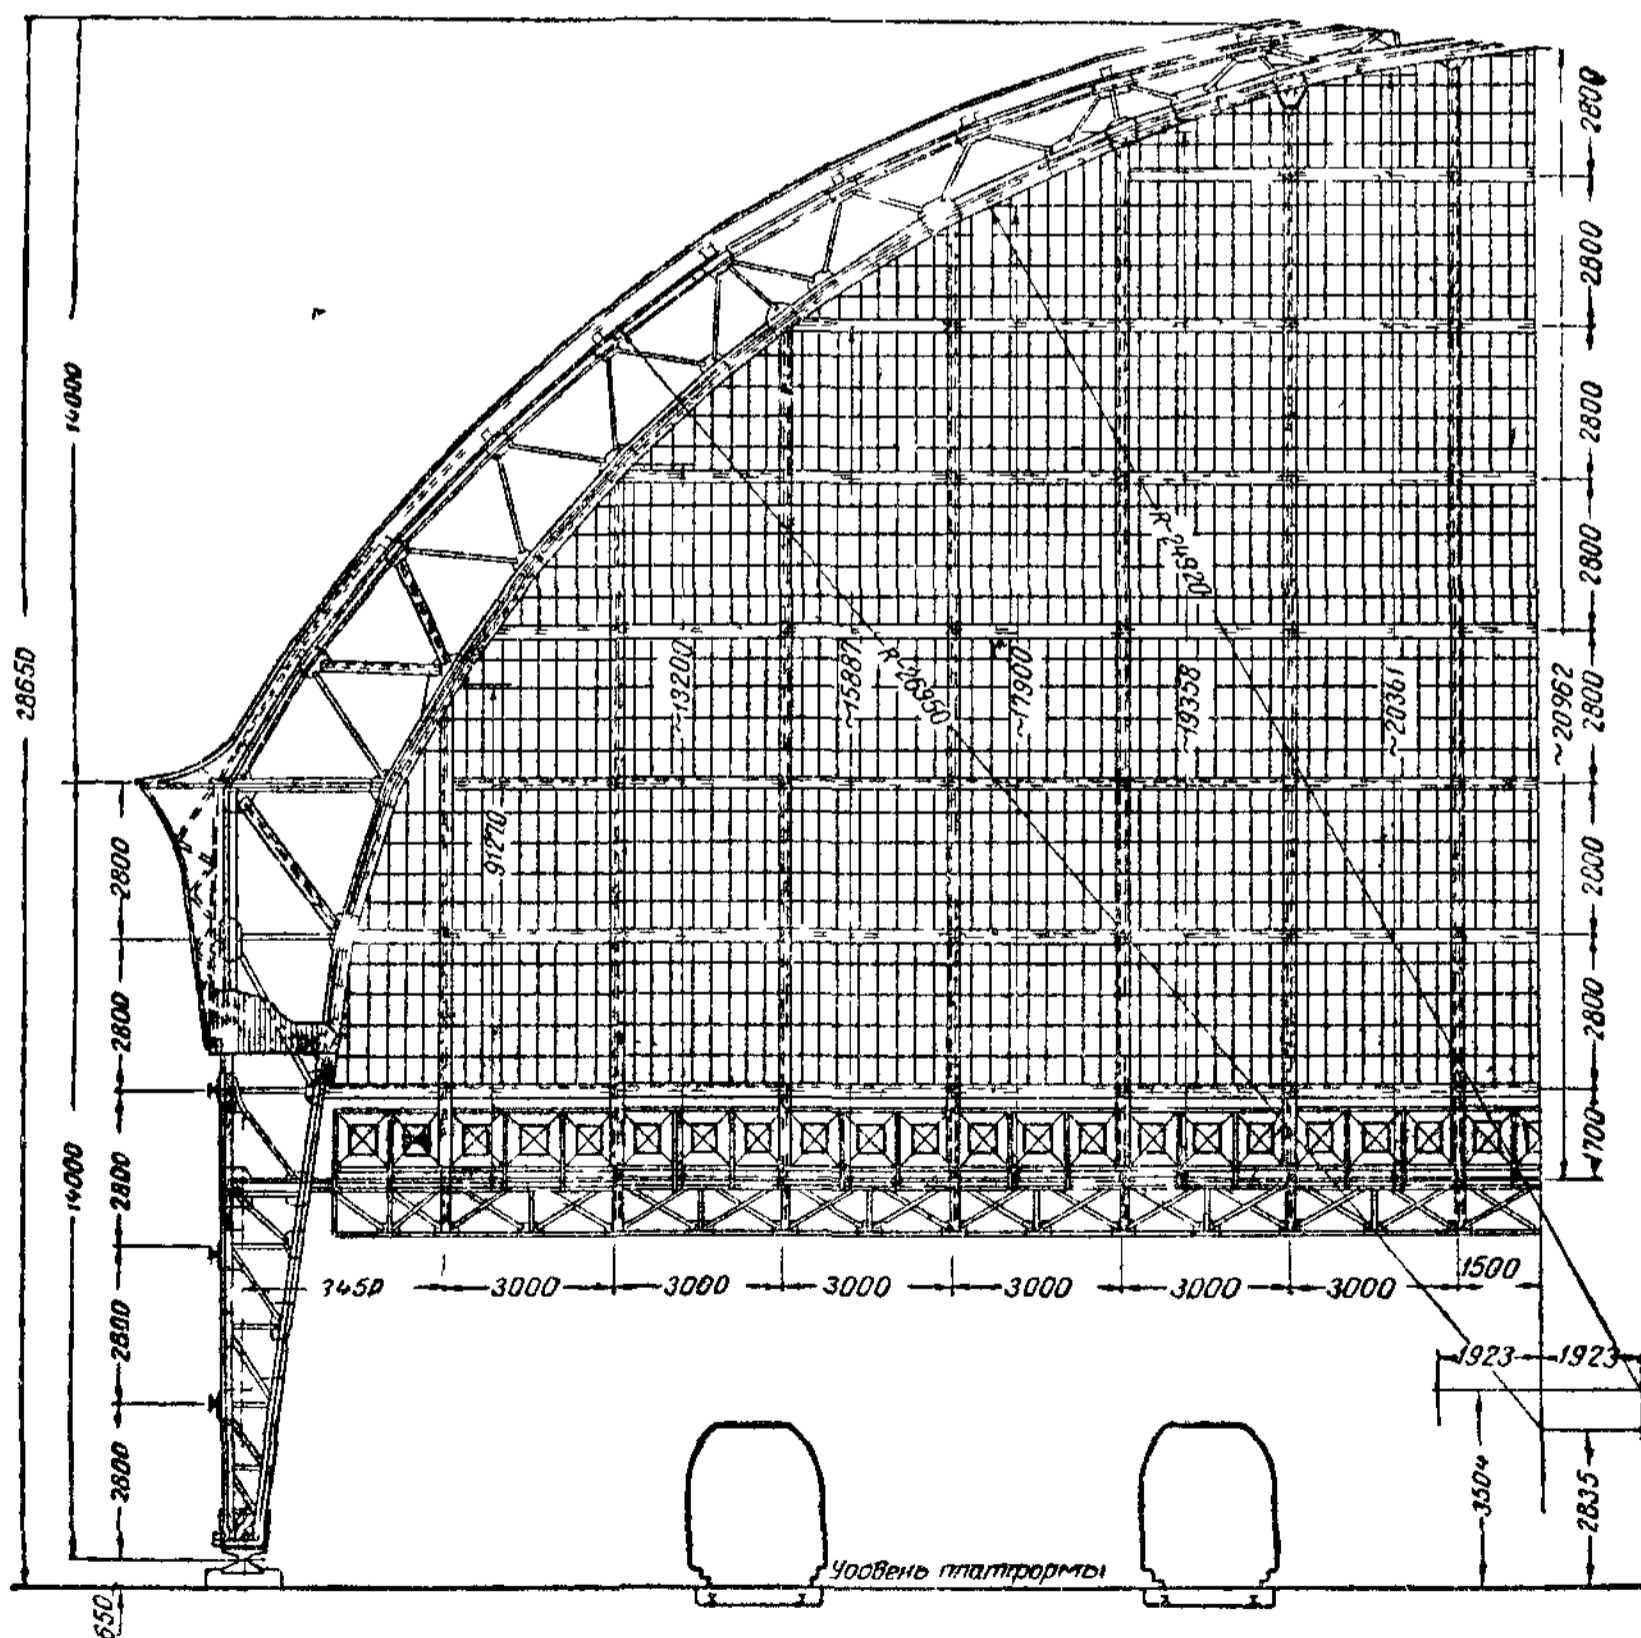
Арка с вертикальным участком над опорами — перекры-
